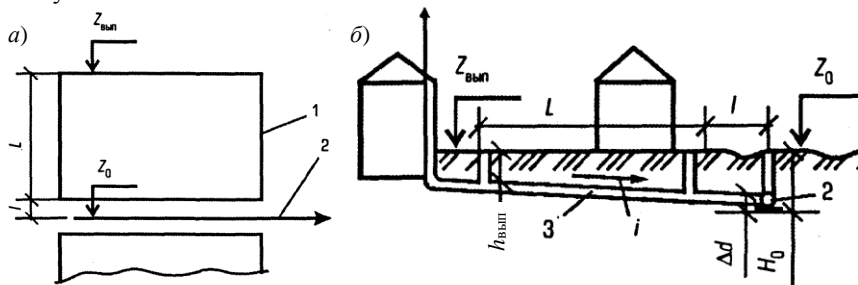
Расчетные схемы к определению начальной минимальной глубины заложения уличного трубопровода:
